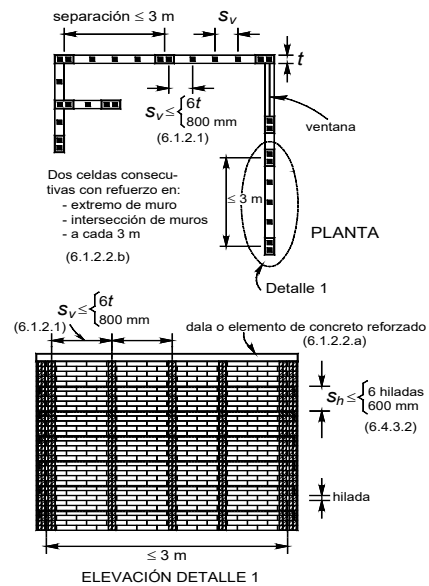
REQUISITOS PARA MAMPOSTERÍA CON REFUERZO INTERIOR
